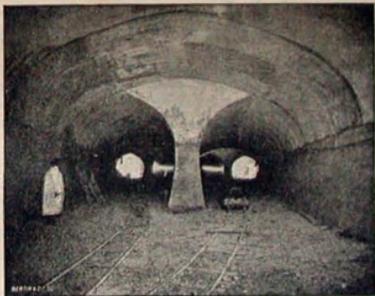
Biforcazione di un tunnel della Metropolitana di Parigi.
